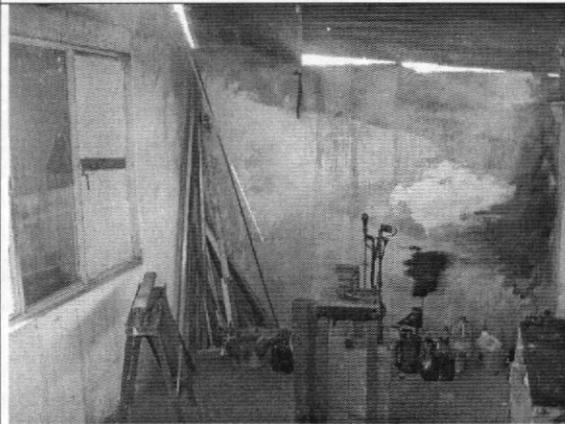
Muros de tercer nivel sin afectaciones estructurales
